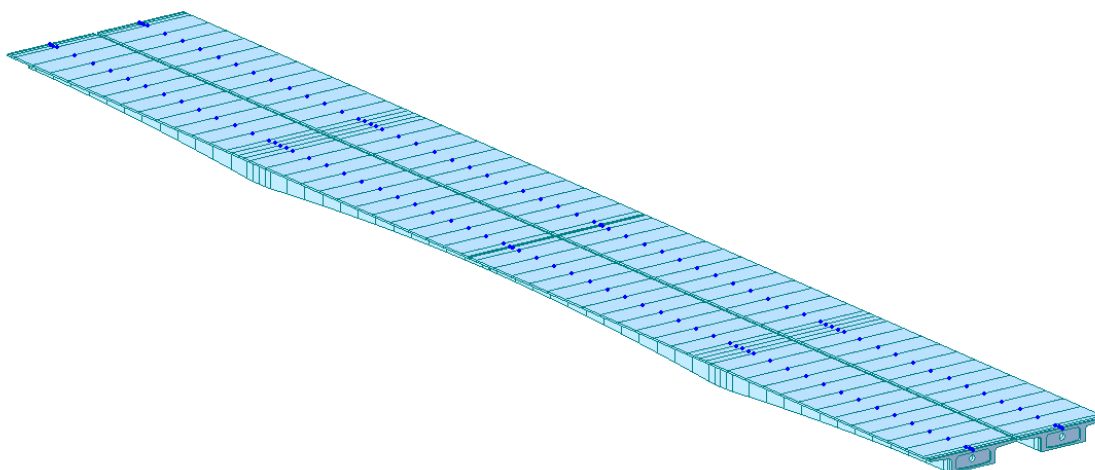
Modellazione dell'impalcato del ponte con elementi beam
